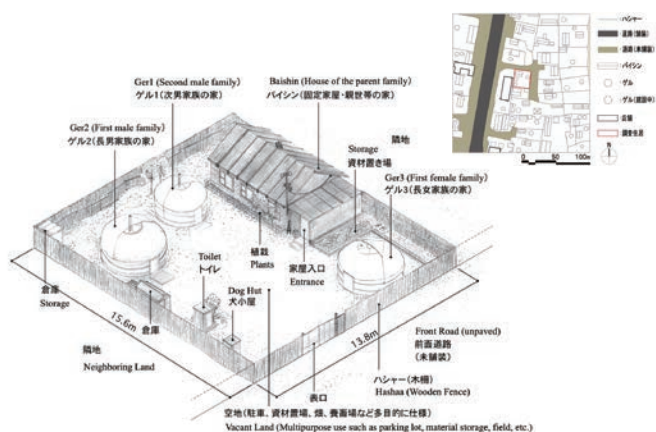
ウランバートル・ゲル地区調査住居 配置図・1階平面図 ー2013年9月 No.10-17 ー
